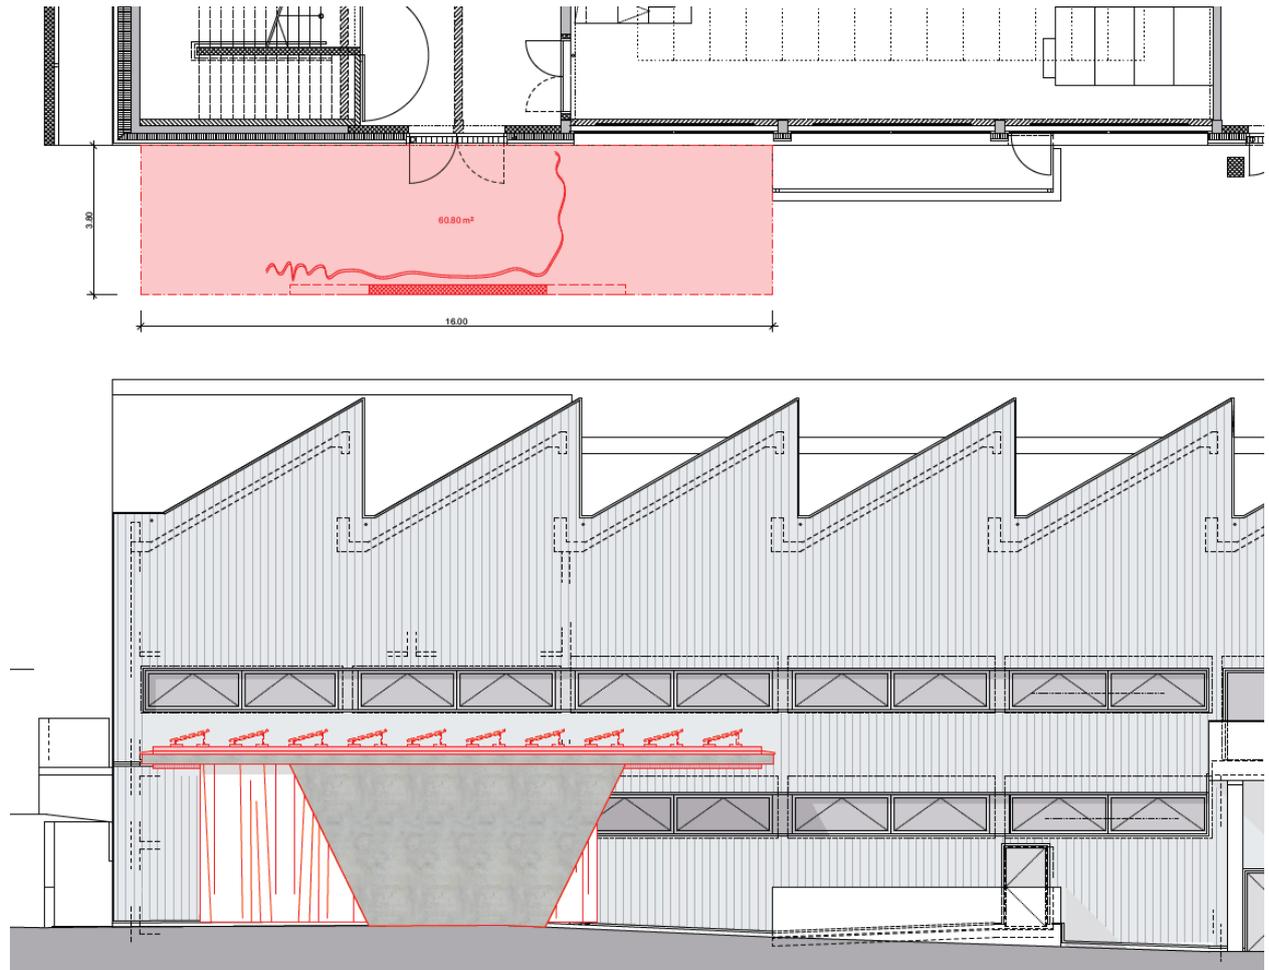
Eingang Club Südpol mit neuem Vordach inkl. Schallschutzmassnahmen (Grundriss und Ansicht)
